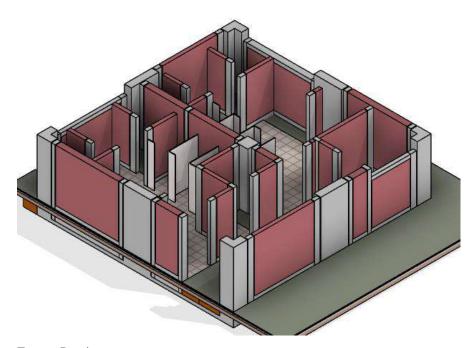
Modelo BIM, Vista en Planta del Segundo Nivel del Módulo B.
